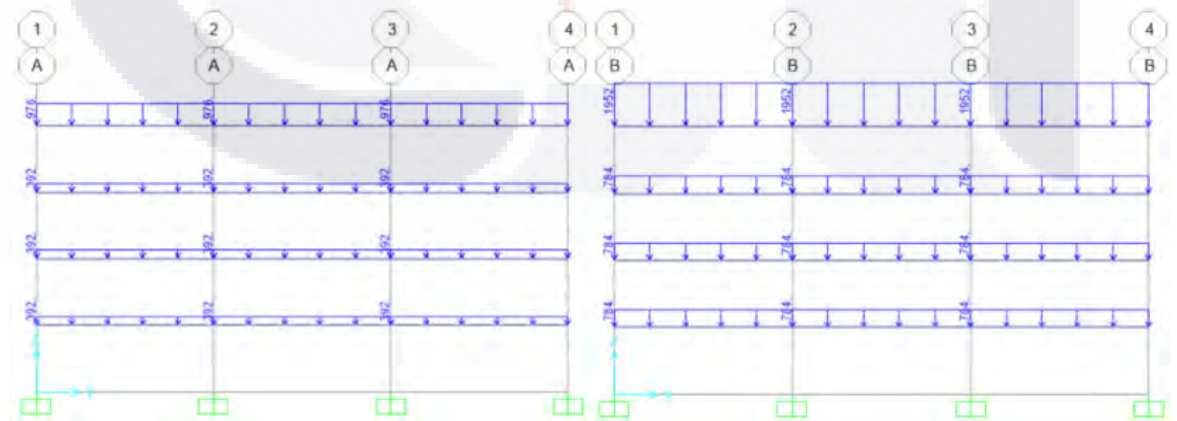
Carga viva aplicada a las traves del eje A, carga viva aplicada en eje B (kg/m)
